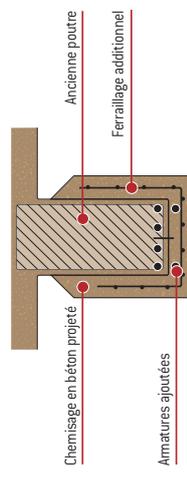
Exemple de renforcement d'une poutre par béton projeté (coupe transversale)
